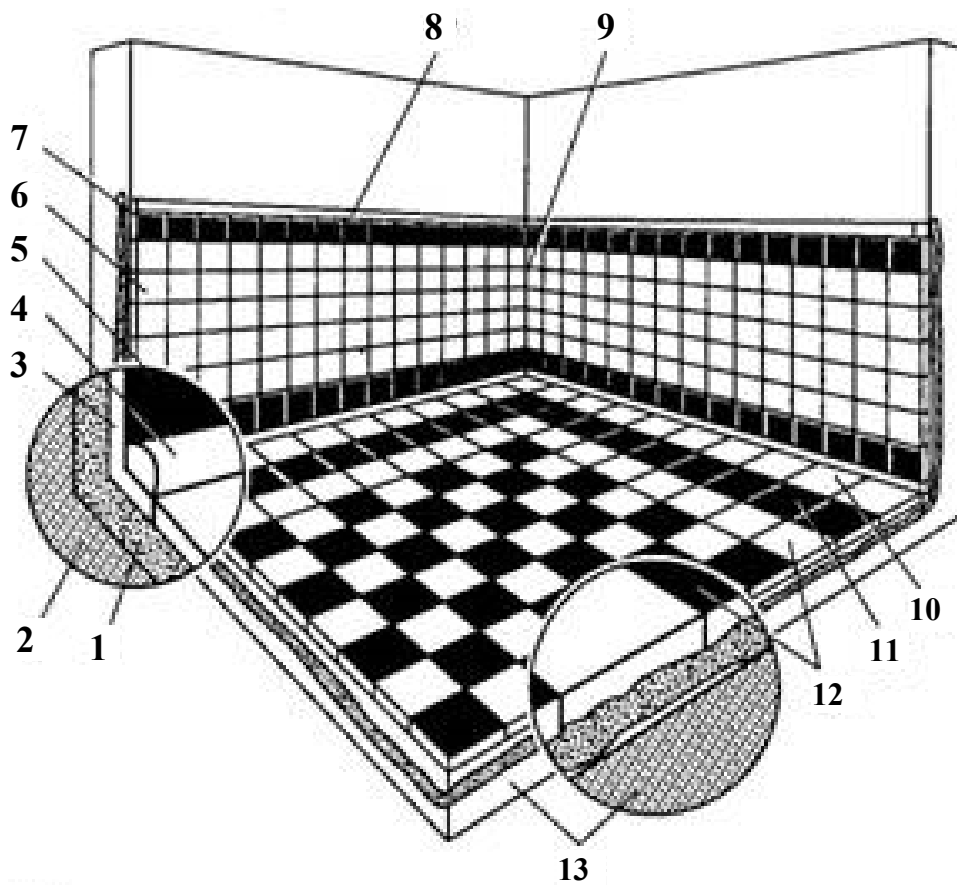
Елементи личкувального покриття: 1 – прошарок з розчину; 2 – жорстка основа; 3 – облицювальне покриття; 4 – плінтус; 5 – цоколь; 6 – основне поле облицювання; 7, 11 – фризи; 8 – карниз; 9 – внутрішній кут; 10 – закладення; 12 – фон; 13 – основа
